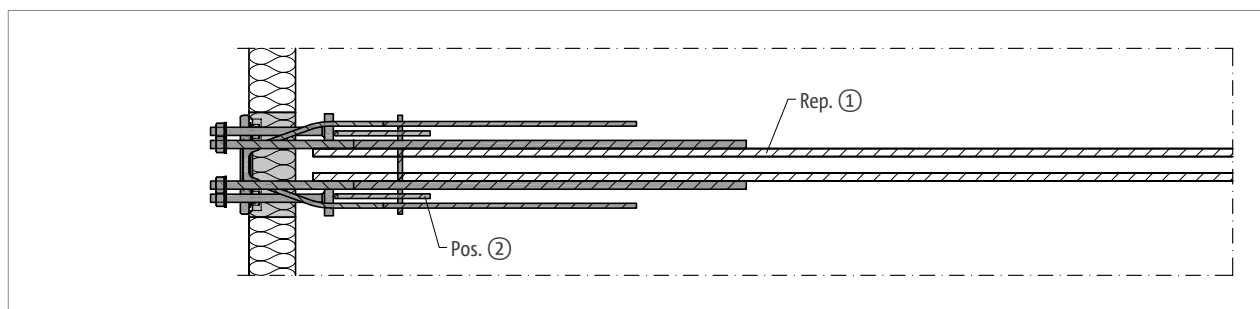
Schöck Isokorb® T type SK-M1 : renforcement sur site, plan de base
